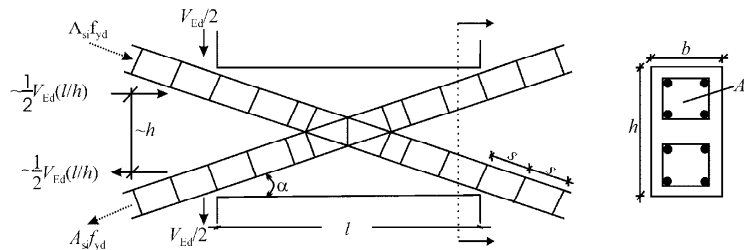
Vigas de acoplamento com armaduras diagonais
